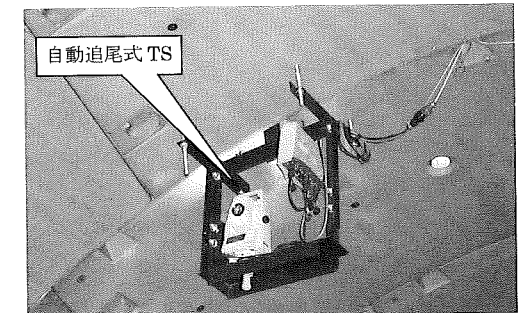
自動追尾式TS設置状況(上部設置)(セグメント内径：φ6,700mm)
